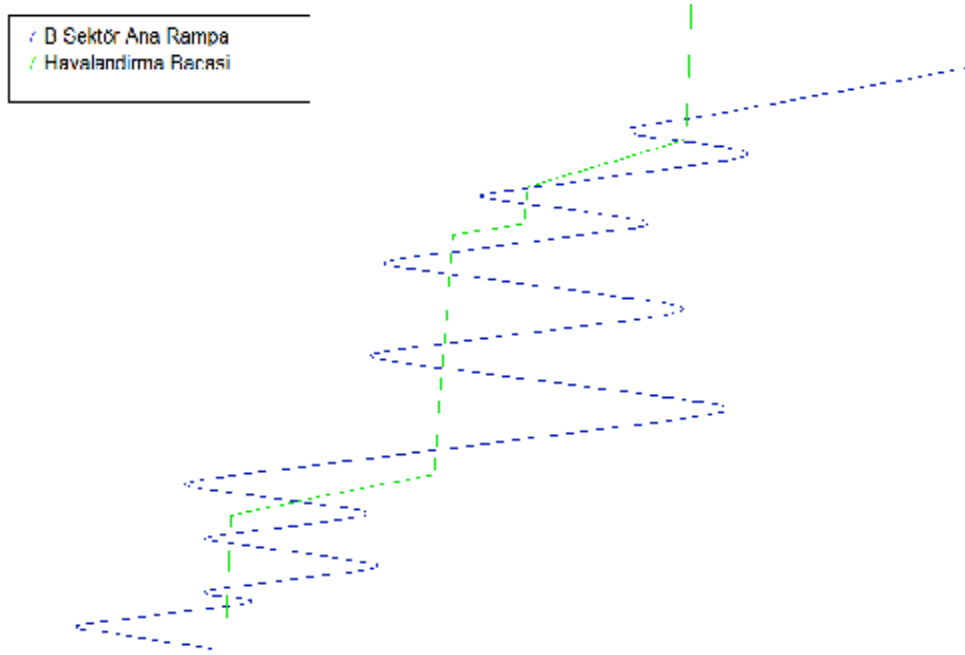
B sektör ana rampa ve havalandırma galerileri planı
